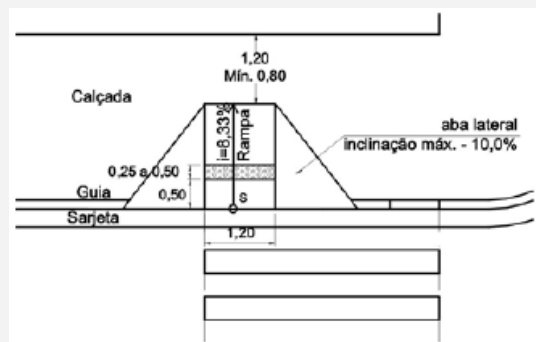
Projeto para rebaixamento de calçadas segundo a Norma da ABNT 9050
